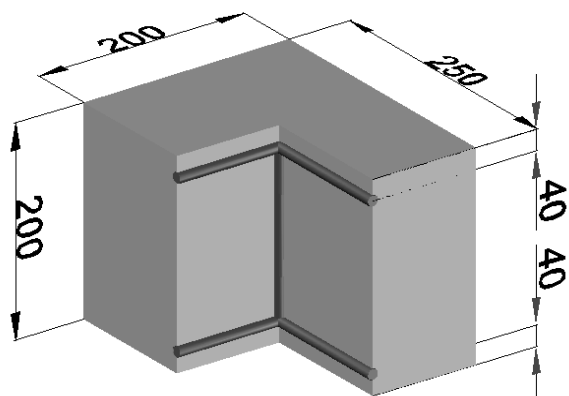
Стандартный фрагмент железобетонного перекрытия с размерами
